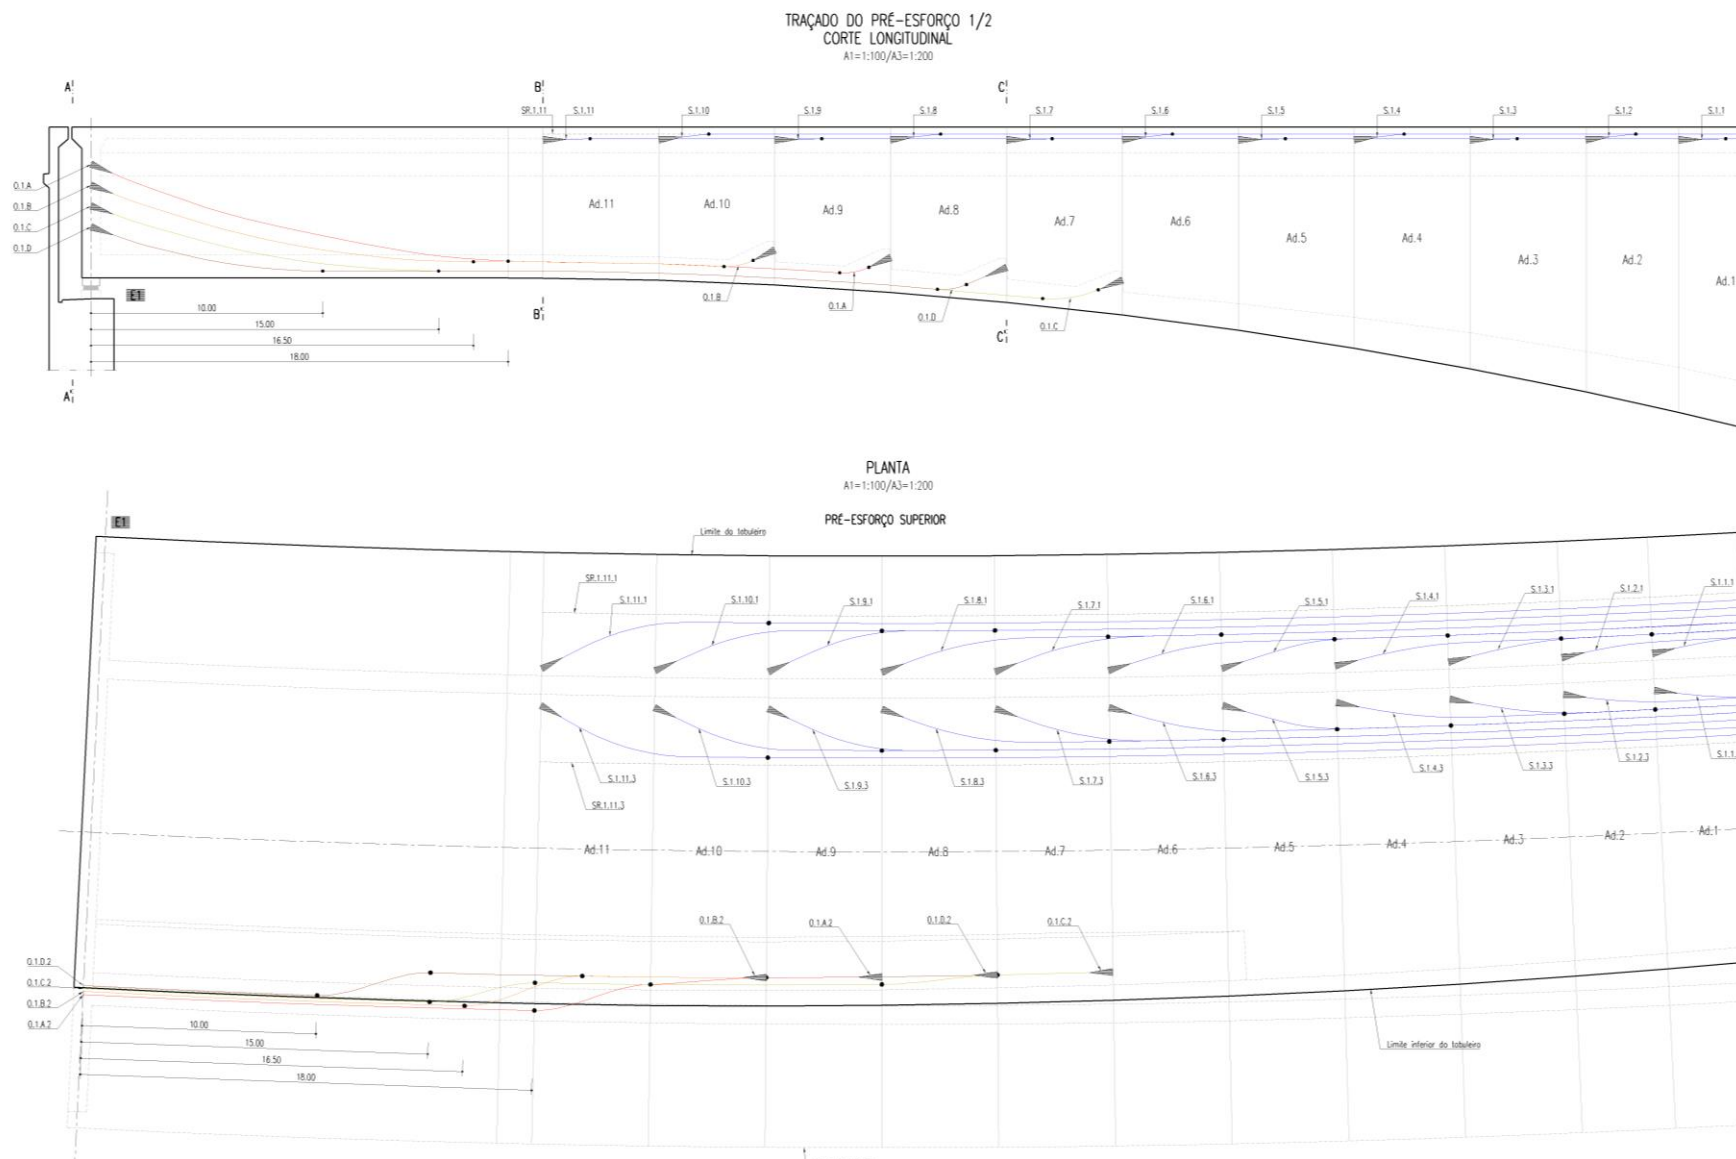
Traçado do Pré-Esforço. Peças Desenhadas do Projeto de Execução - 1/2
